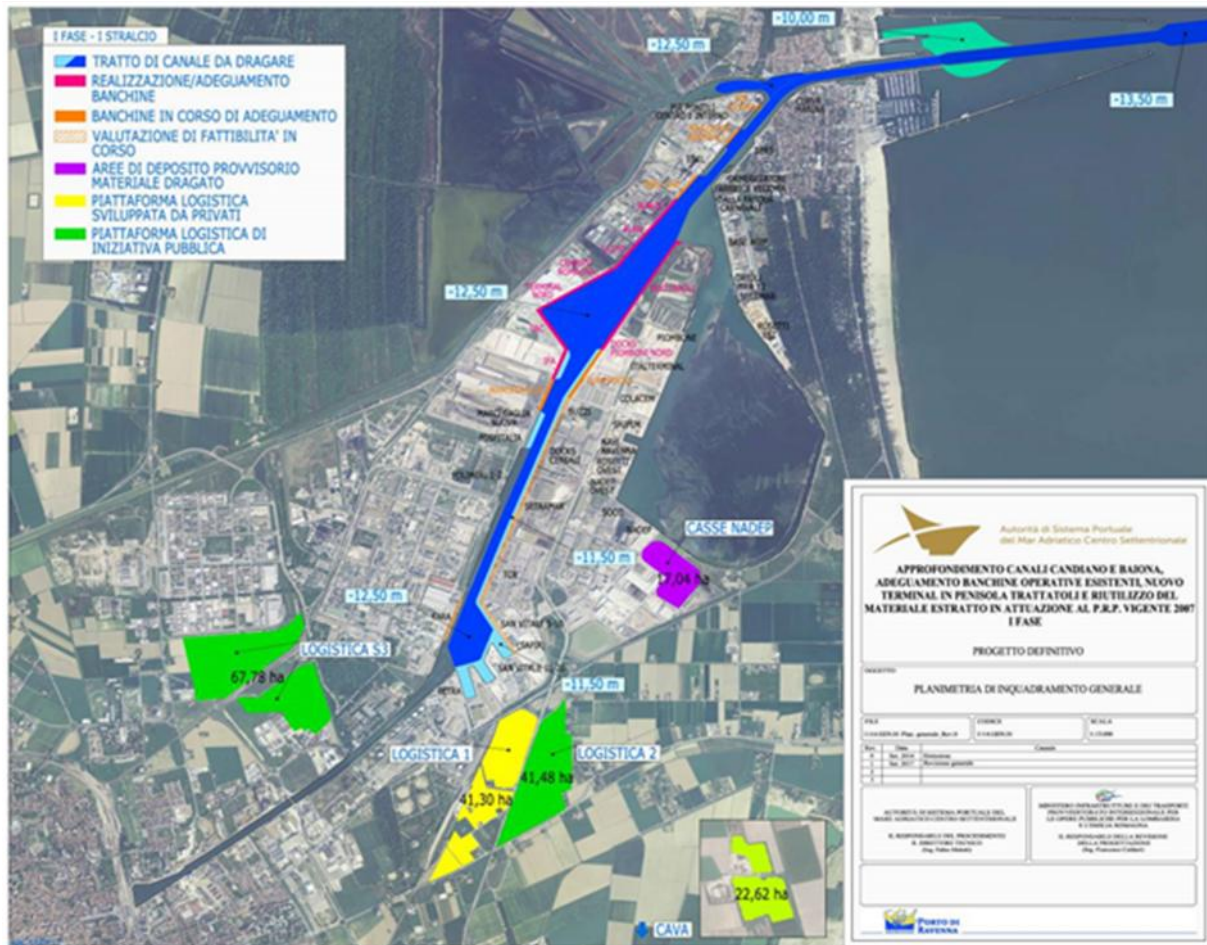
Planimetria di inquadramento generale Progetto HUB – progetto definitivo [stralcio da elaborato 1114.GEN.01]
